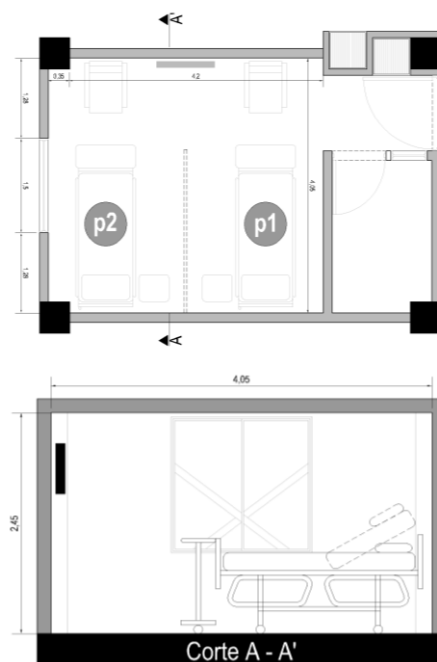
Cuarto típico. Planta y Corte A- A'.
